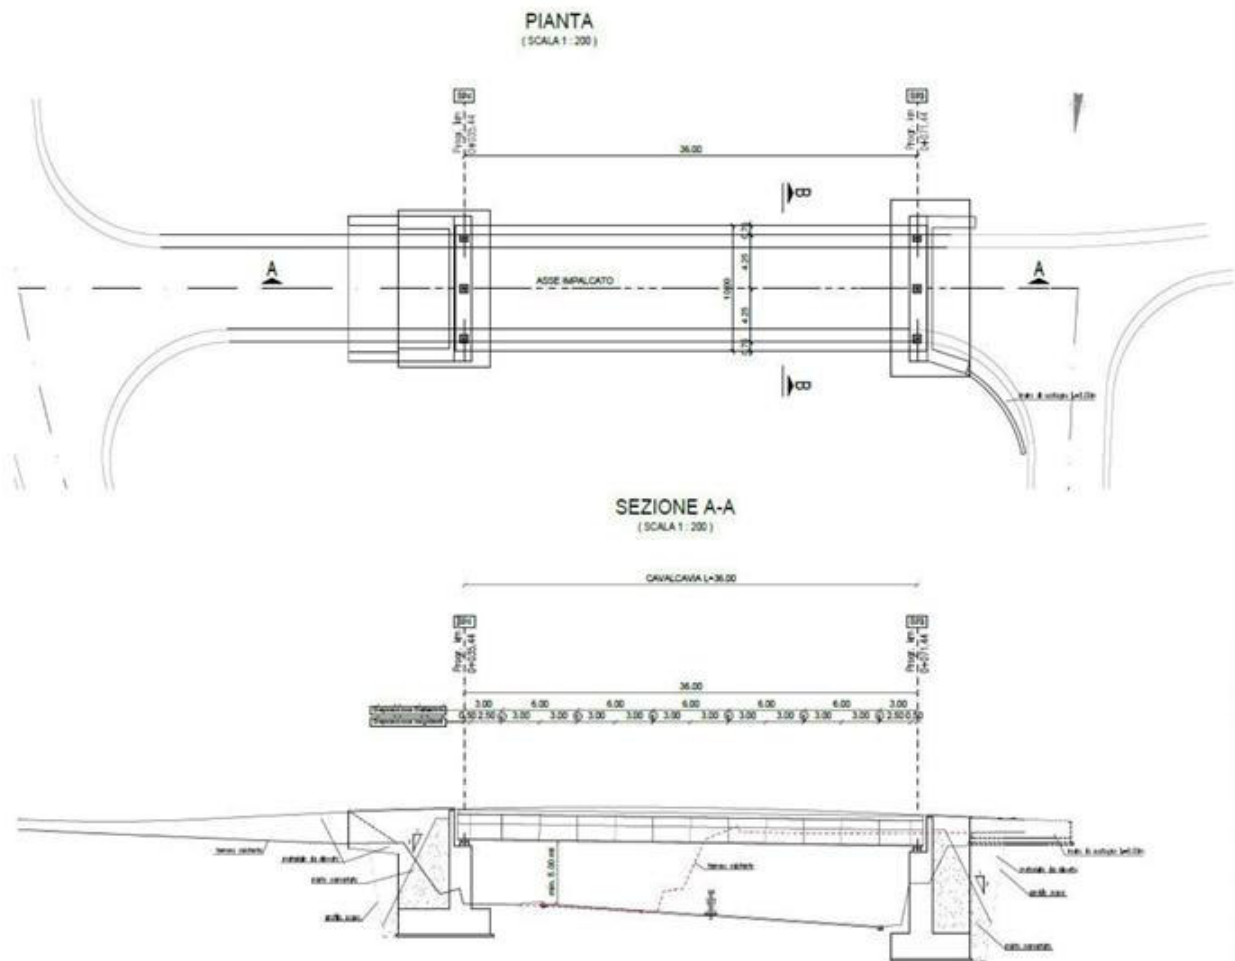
Planimetria e sezione cavalcavia km 1+800
